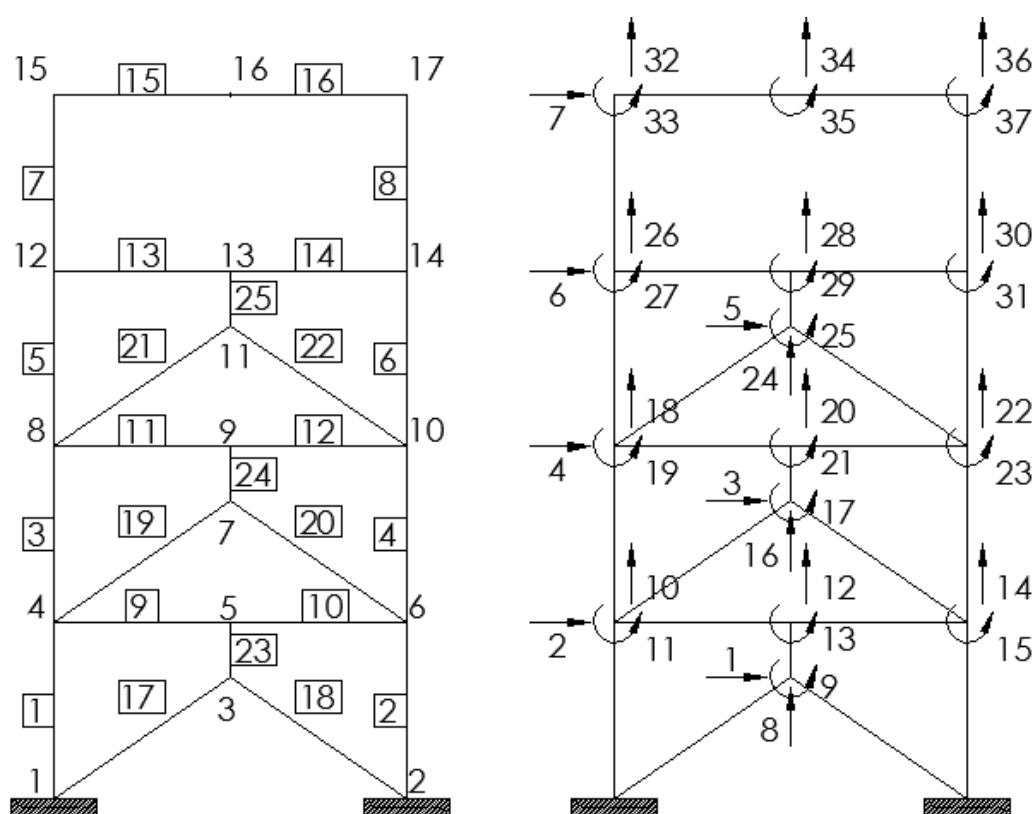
Geometría de un pórtico plano de 4 pisos de hormigón armado, con disipadores de energía colocados sobre contraviento Chevrón.
